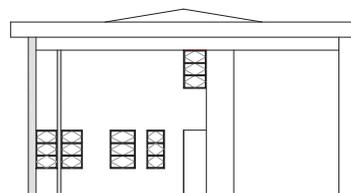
FACHADA OESTE Fonte: desenho da autora.
